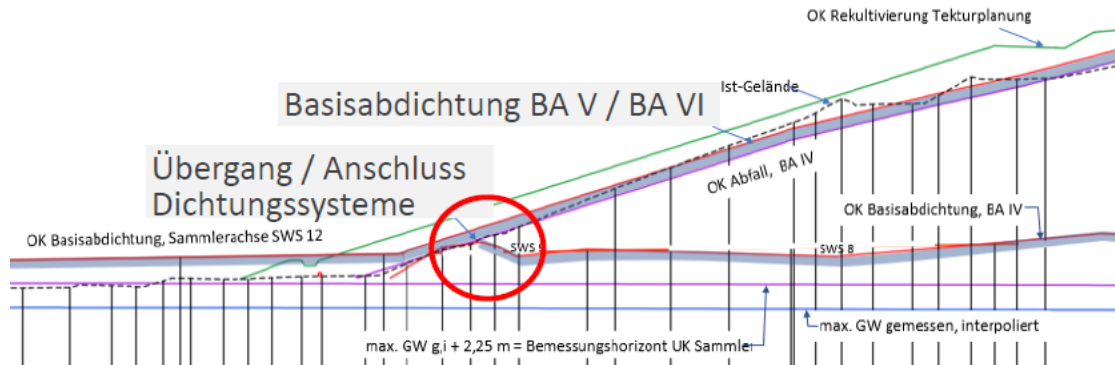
Lage Übergang / Anschluss Dichtungssysteme Böschungsfuß überlagerte Bestandsdeponie
